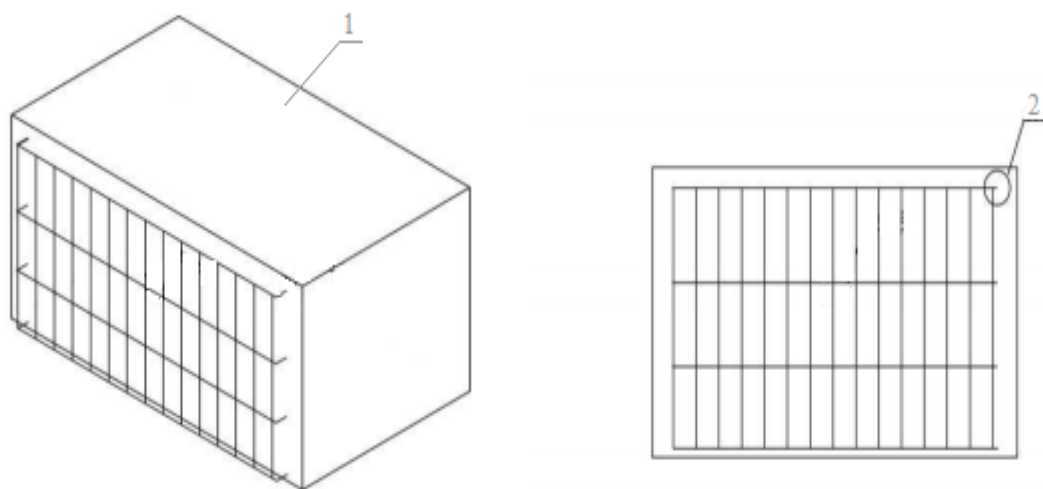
Посилена деталь кріплення троса до фасаду будівлі
